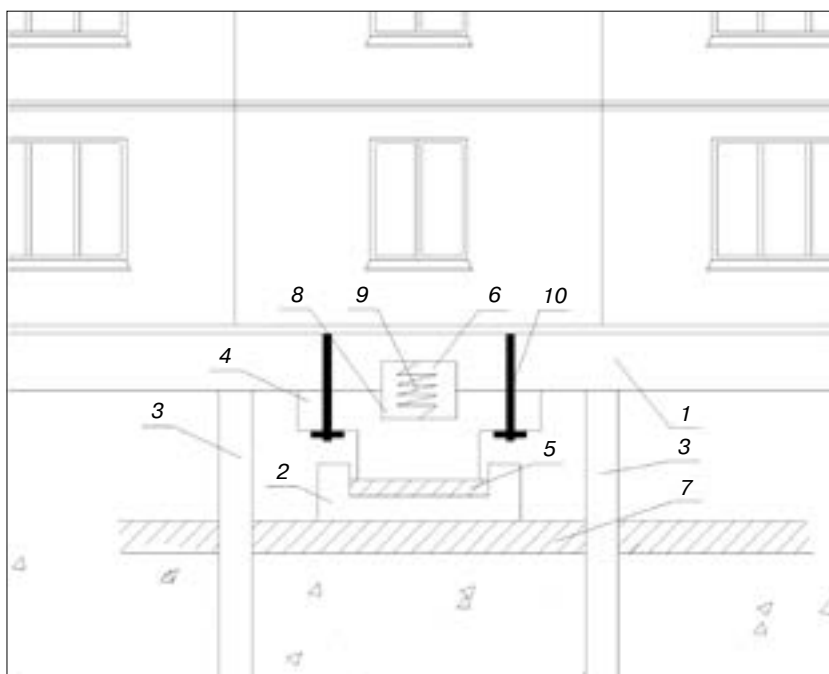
Сейсмостойкий свайный фундамент (вариант 2)
